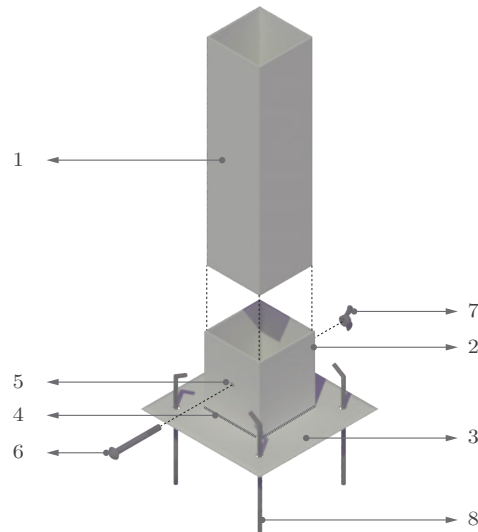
Detalle de la conexión de la estructura externa al piso del habitáculo Emergency Expa Room. Fuente y elaboración: Autores.
